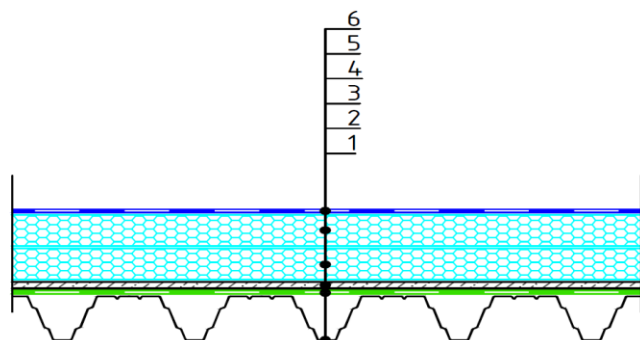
Схема покрытия (крыши) с полимерной теплоизоляции со сборной стяжкой из ГВЛ
